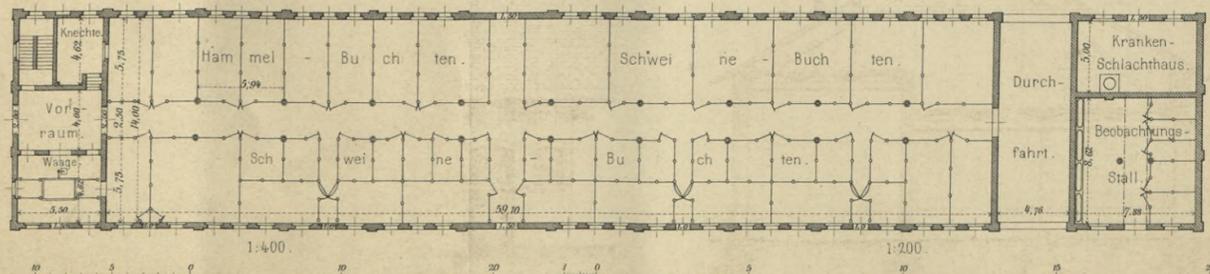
Grundriss des Kleinviehstalles mit Krankenstall und Kranken-Schlachthaus. 1:400.
